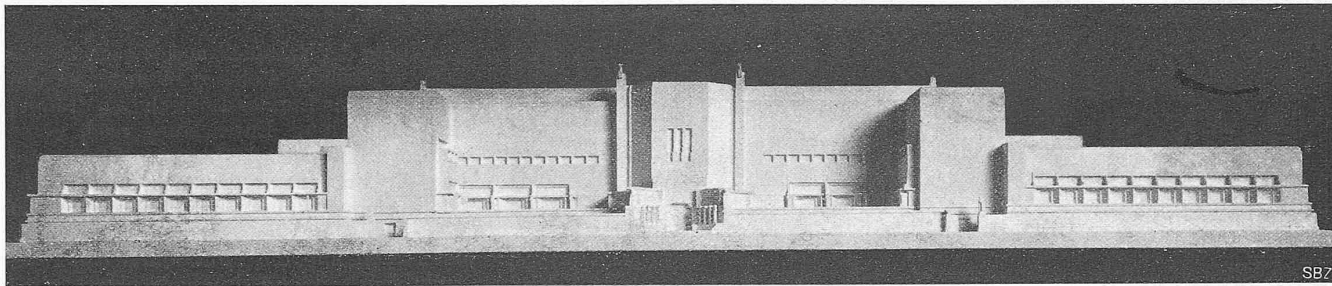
Reichsakademie für bildende Künste in Amsterdam. Entwurf 1921 der Arch. B. Bijvoet und J. Duiker. Stark monumentale Gruppierung der Massen, Steigerung der Flächenwirkung durch das Zusammenfassen der Fensteröffnungen.
